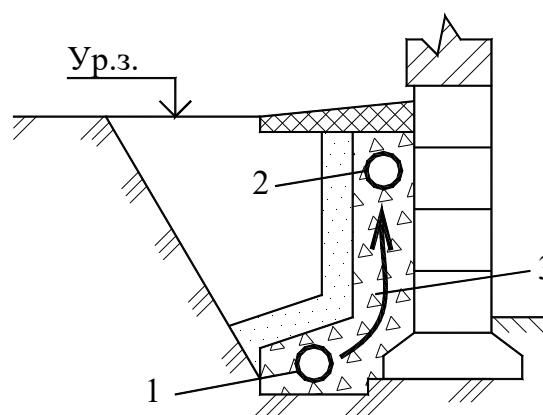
Вентиляционный пристенный дренаж: 1 – воздухоприточная дрена; 2 – вытяжная дрена; 3 – поток воздуха
